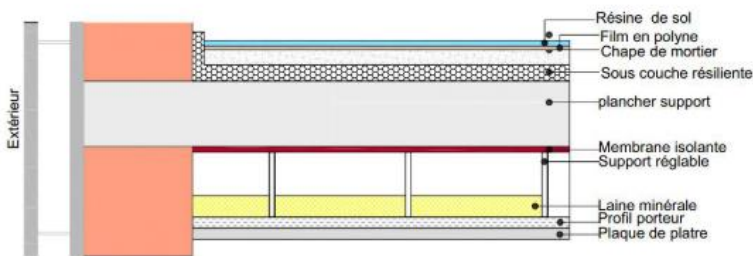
Coupe d'isolation Plancher avec isolant Source: Pintrest.com
